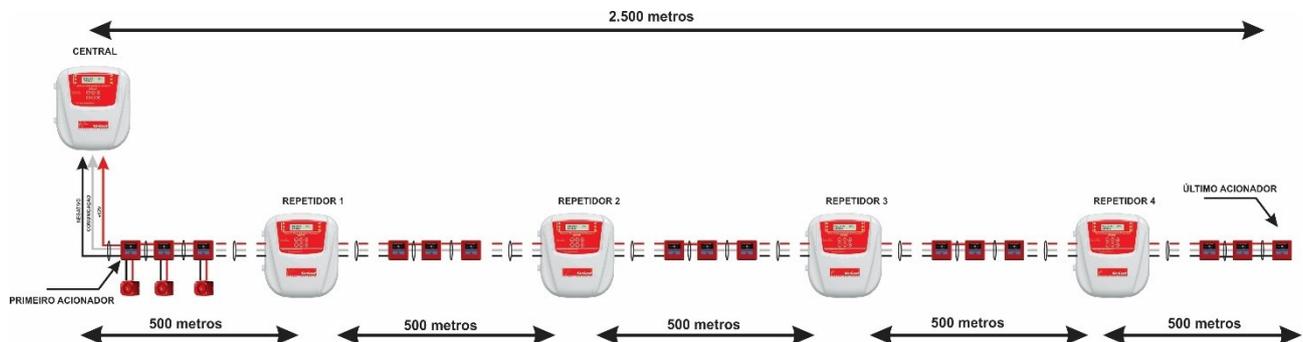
11: Esquema de ligação para cabeamento com 2.500 metros.
